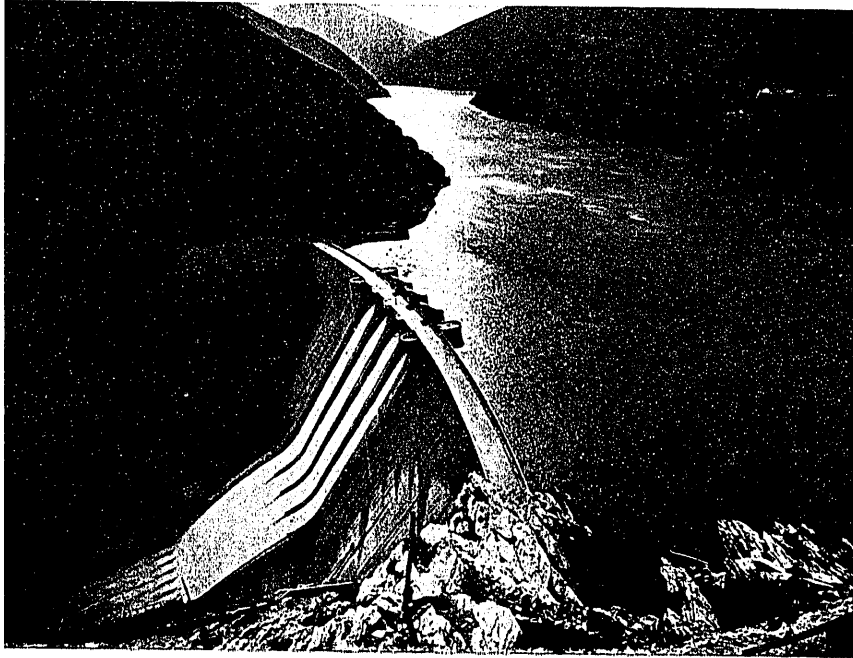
Presa de Salime* vertiendo al terminar su construcción.
